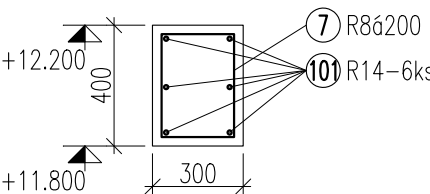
DETAIL PROVÁZÁNÍ KOLMÝCH VĚNCŮ A PRŮVLAKŮ
